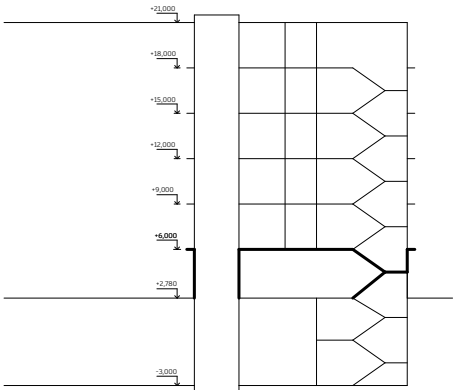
DETAIL ULOŽENÍ PREFA SCHODIŠTĚ M 1:50
